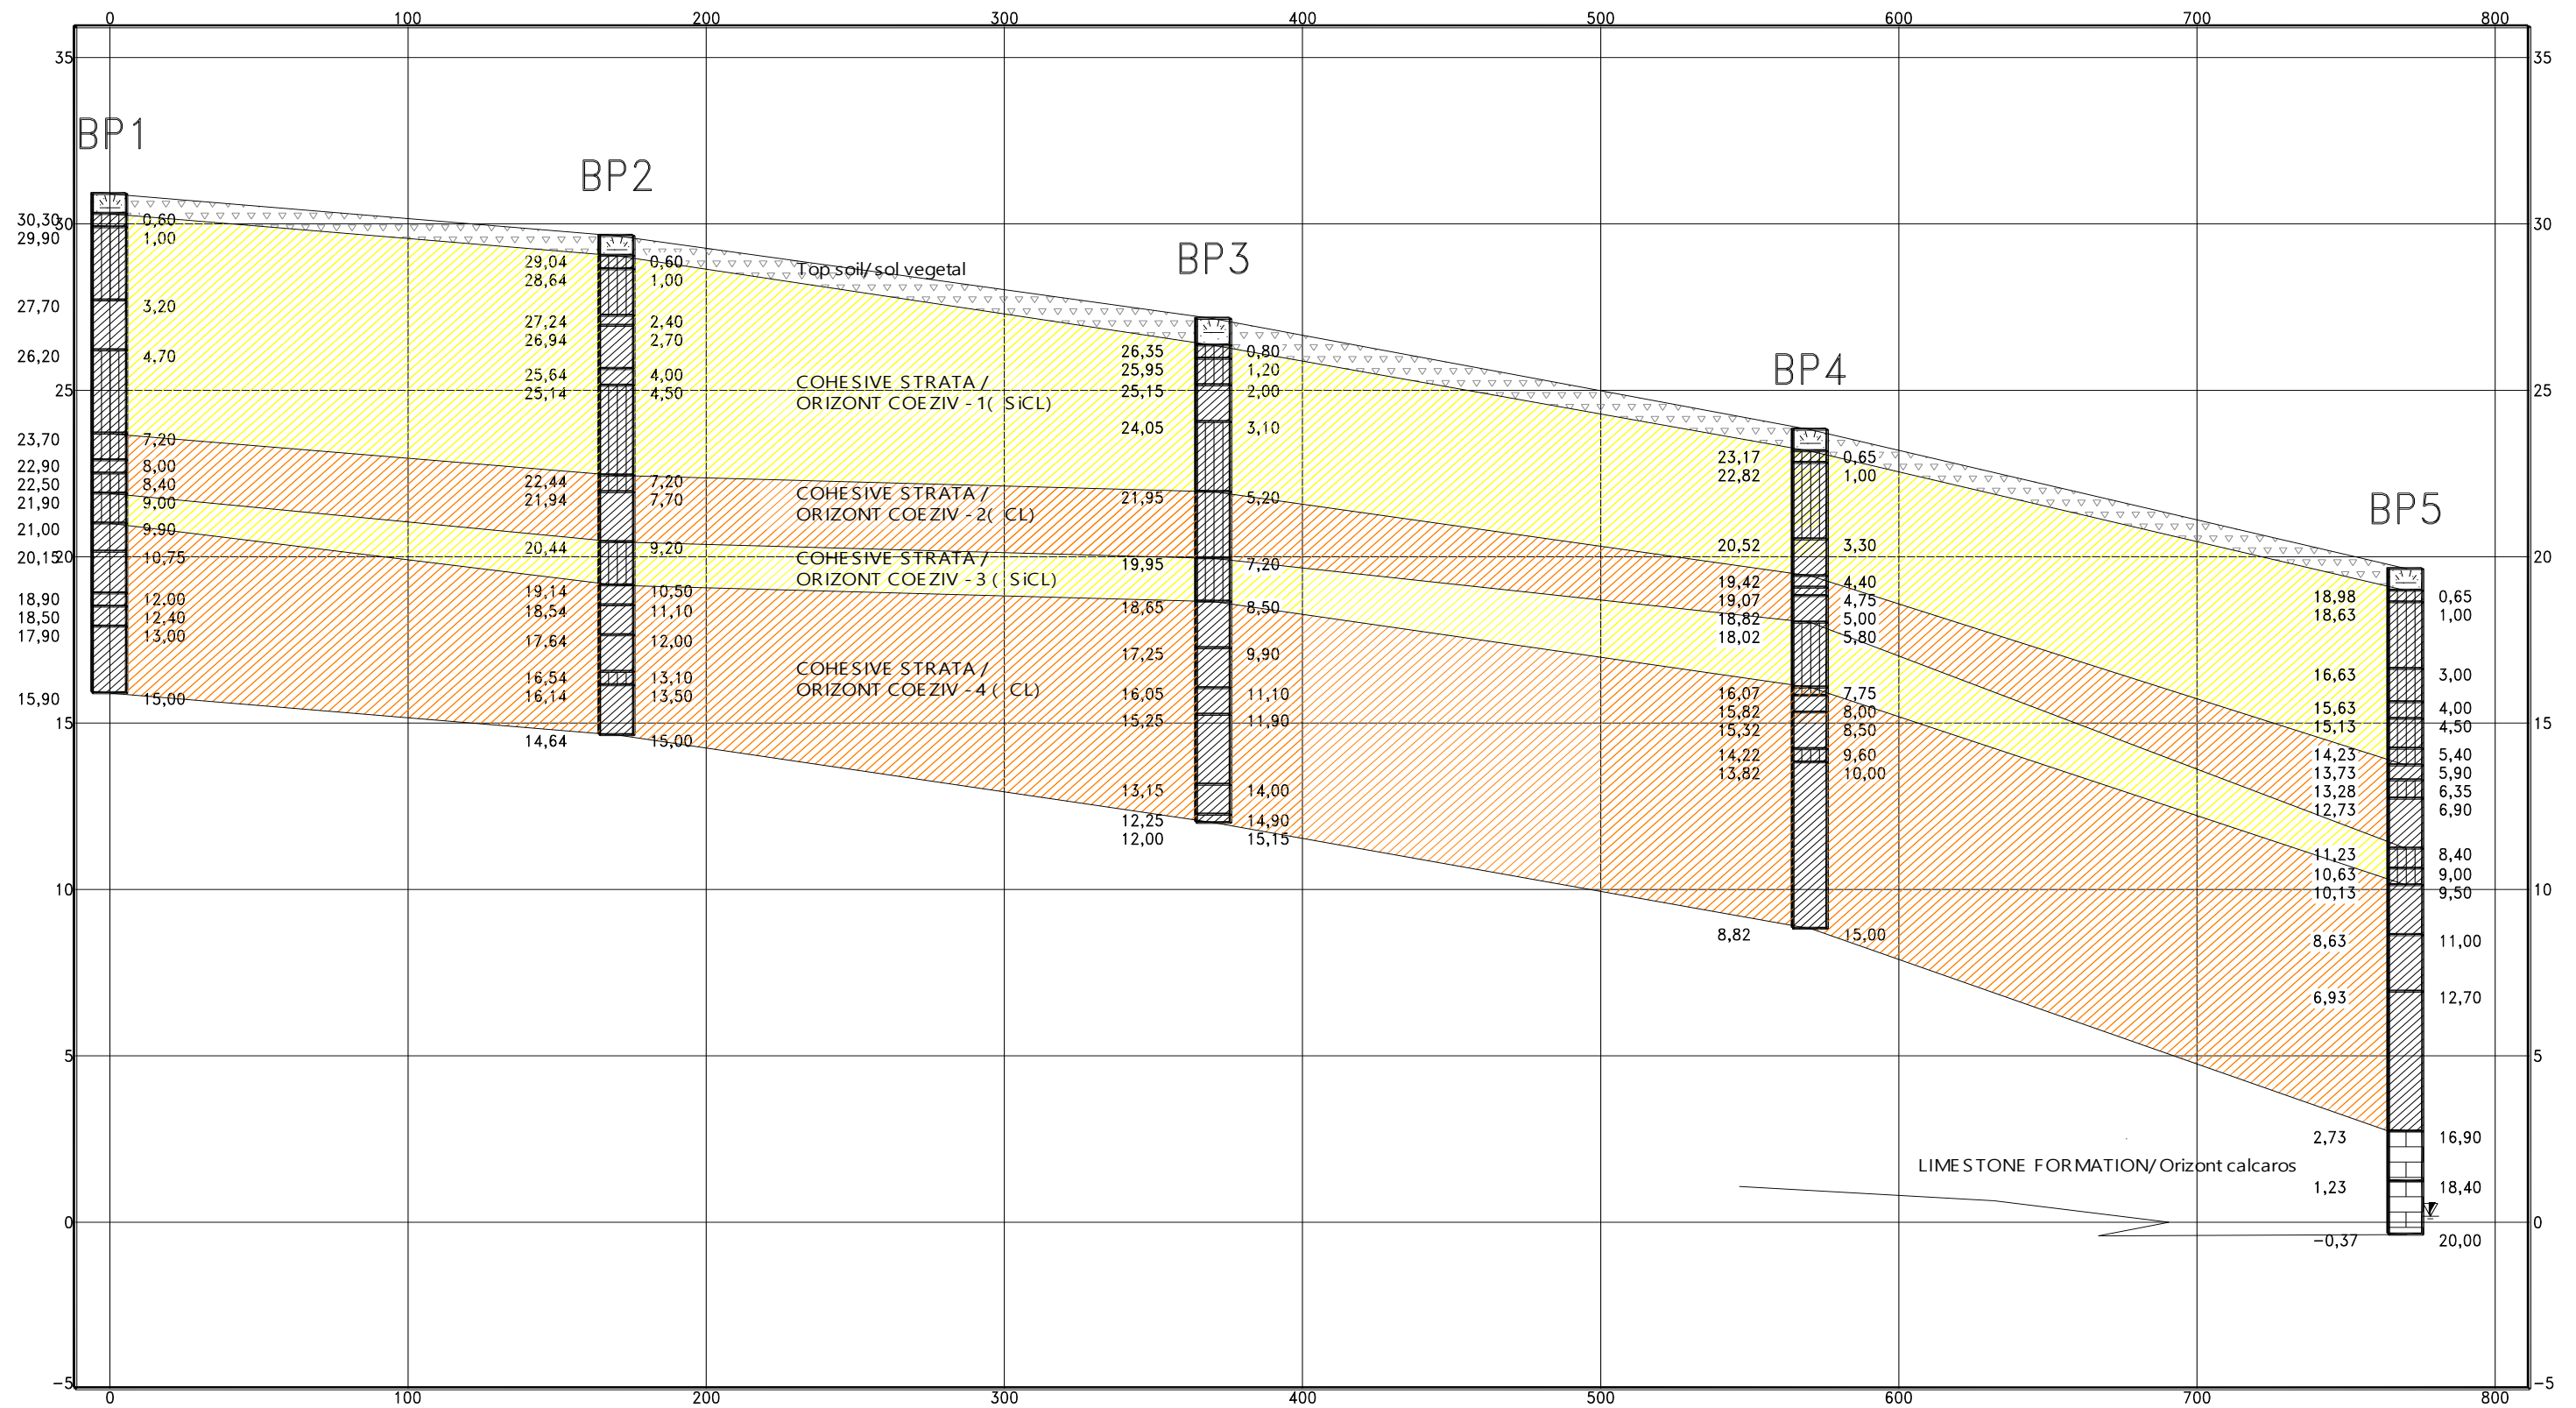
Secțiune transversală subsol în zona de instalare subterană a conductei de producție gaz
